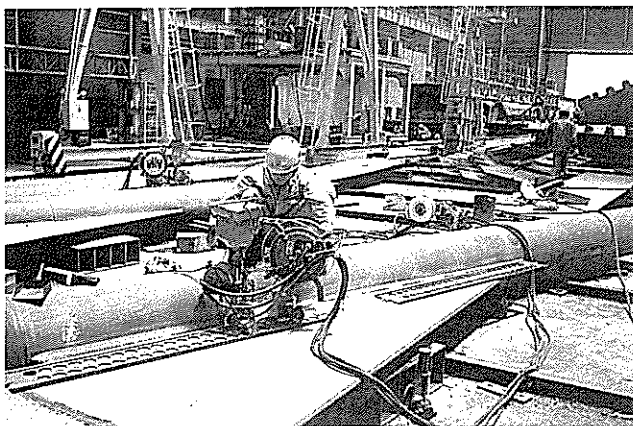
腹板と定着鋼管の突合せ溶接状況
